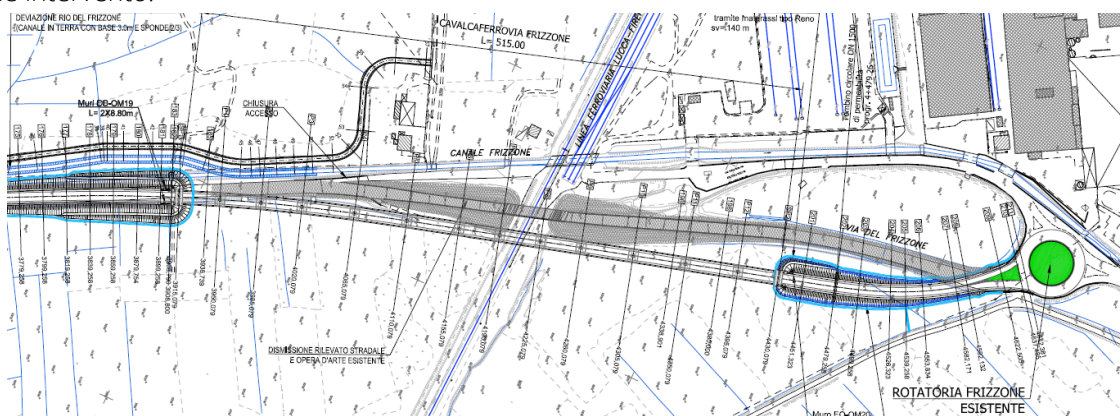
Cavalcaferrovia Frizzone: stralcio planimetrico
